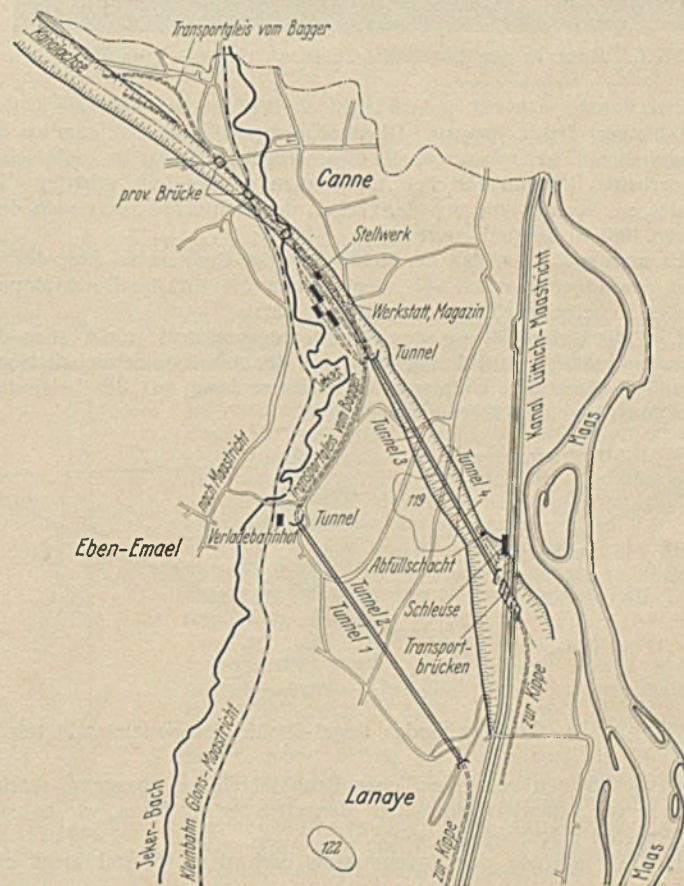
Lageplan des Tunnels für den Abtransport der Abtragmassen nach den Kippstellen im Maastal.
